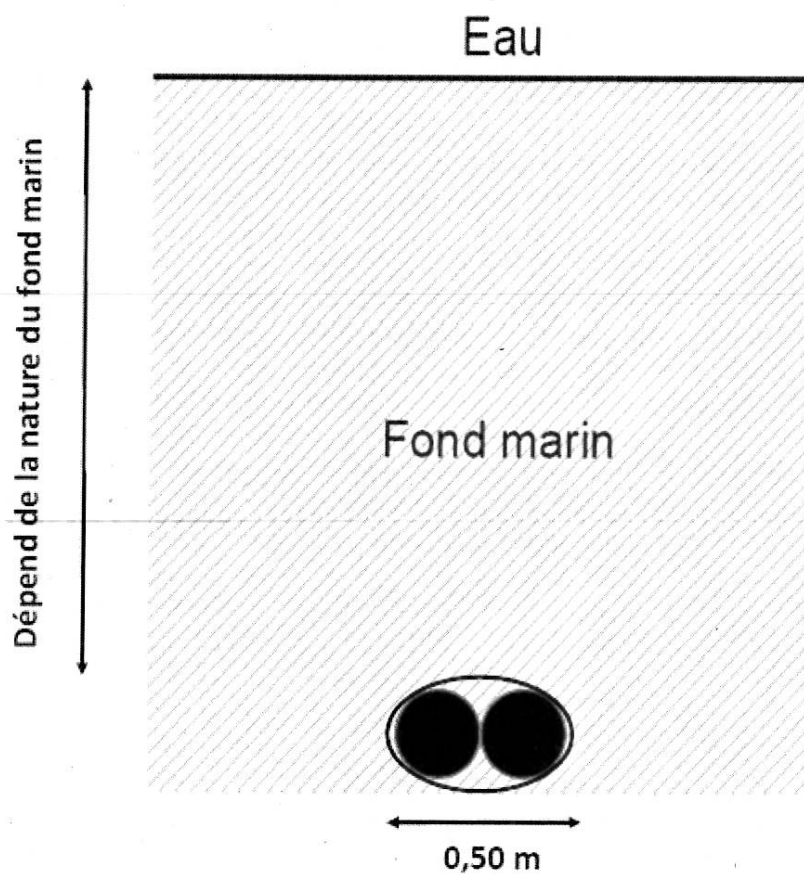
Câbles jointifs ensouillés dans le fond marin en pleine mer - vue en coupe
